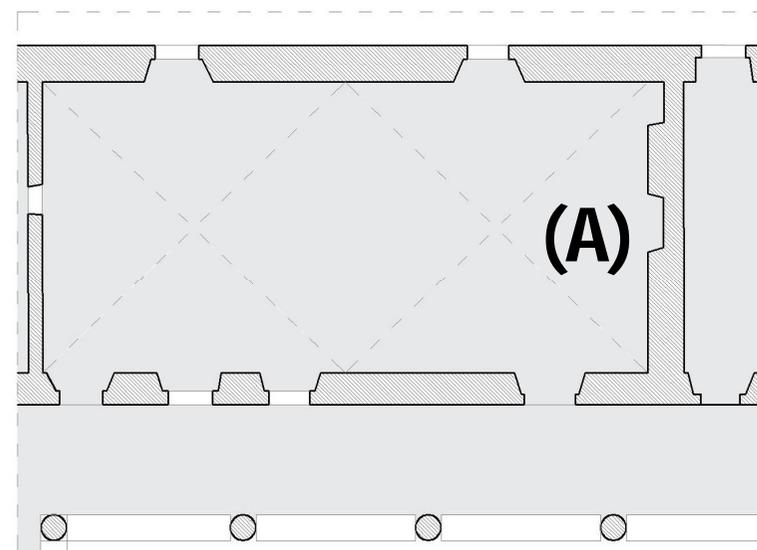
planimetria del refettorio con indicata la posizione dell'affresco (A)
